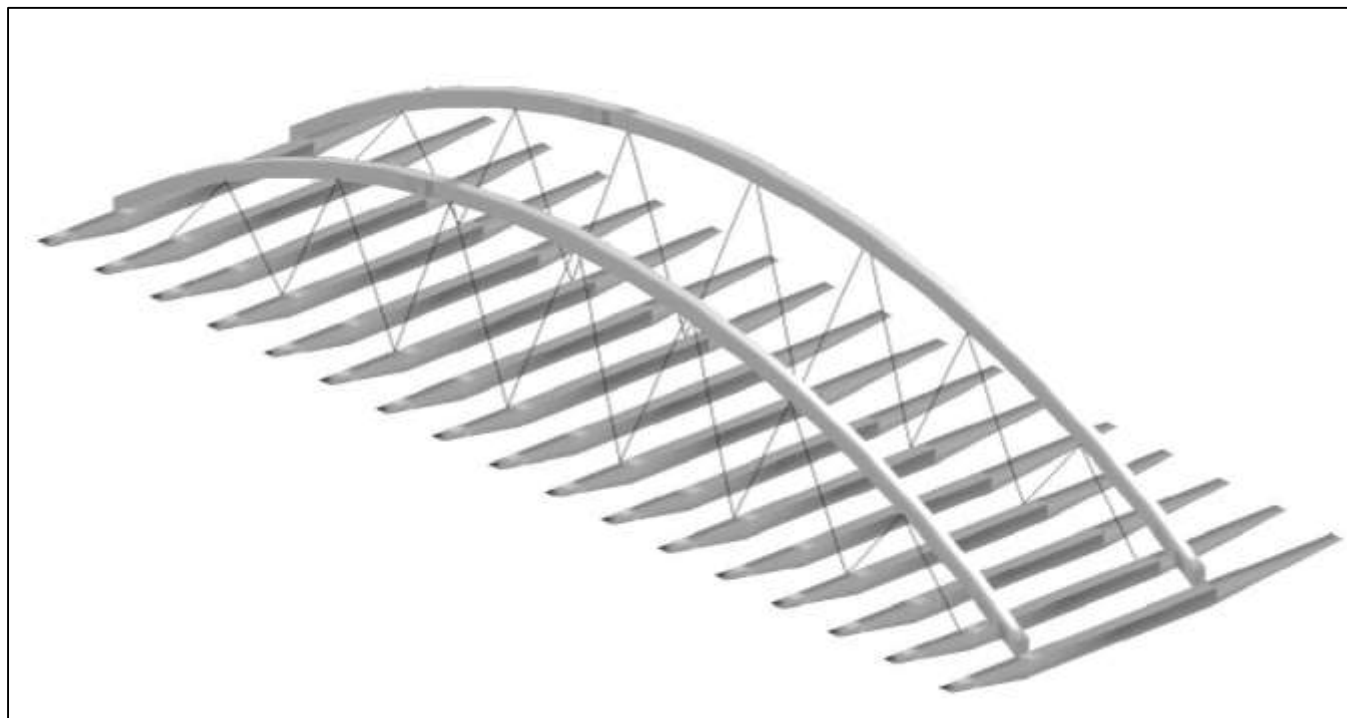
Vista general del sistema primario. Fuente: Elaboración propia.
